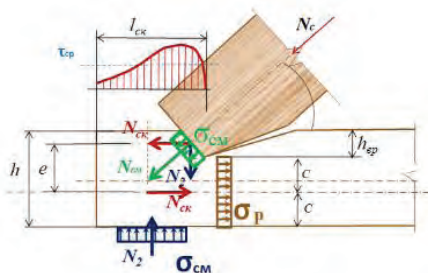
Схема расчета лобовой врубки на смятие и скалывание в нижнем поясе фермы
